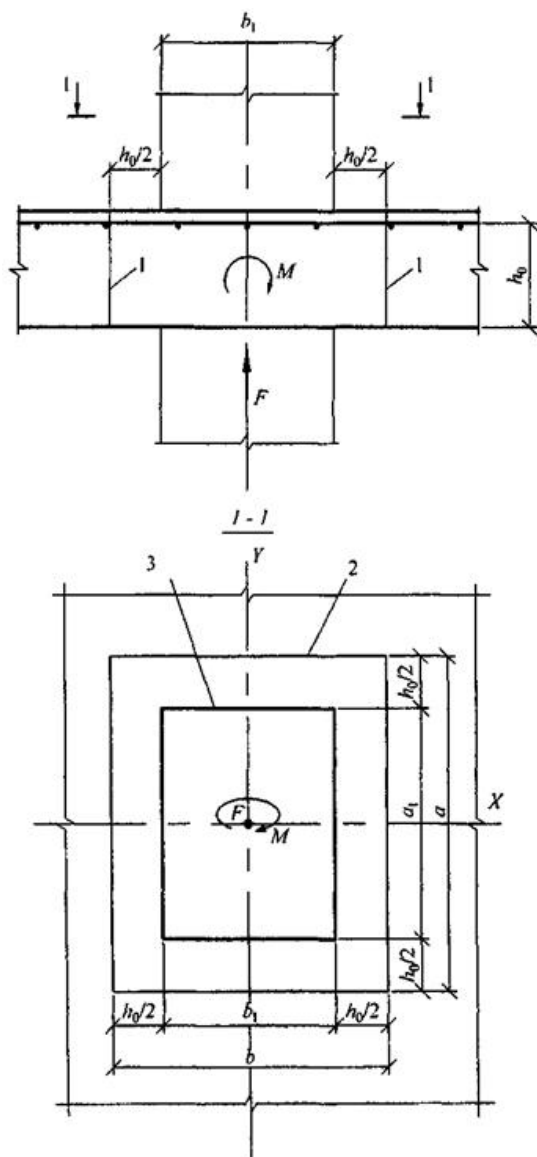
Схема для расчета железобетонных элементов без поперечной арматуры на продавливание: 1 – расчетное поперечное сечение; 2 – контур расчетного поперечного сечения; 3 – контур площадки приложения нагрузки
